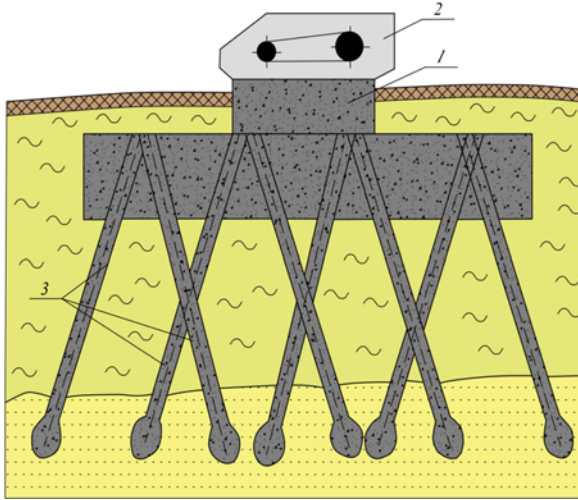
Усиление основания фундамента при увеличенных динамических нагрузках: 1 – усиливаемый фундамент; 2 – источник динамических нагрузок; 3 – сваи ЭРТ (РИТ, ФОРСТ, ЭРСТ) усиления
